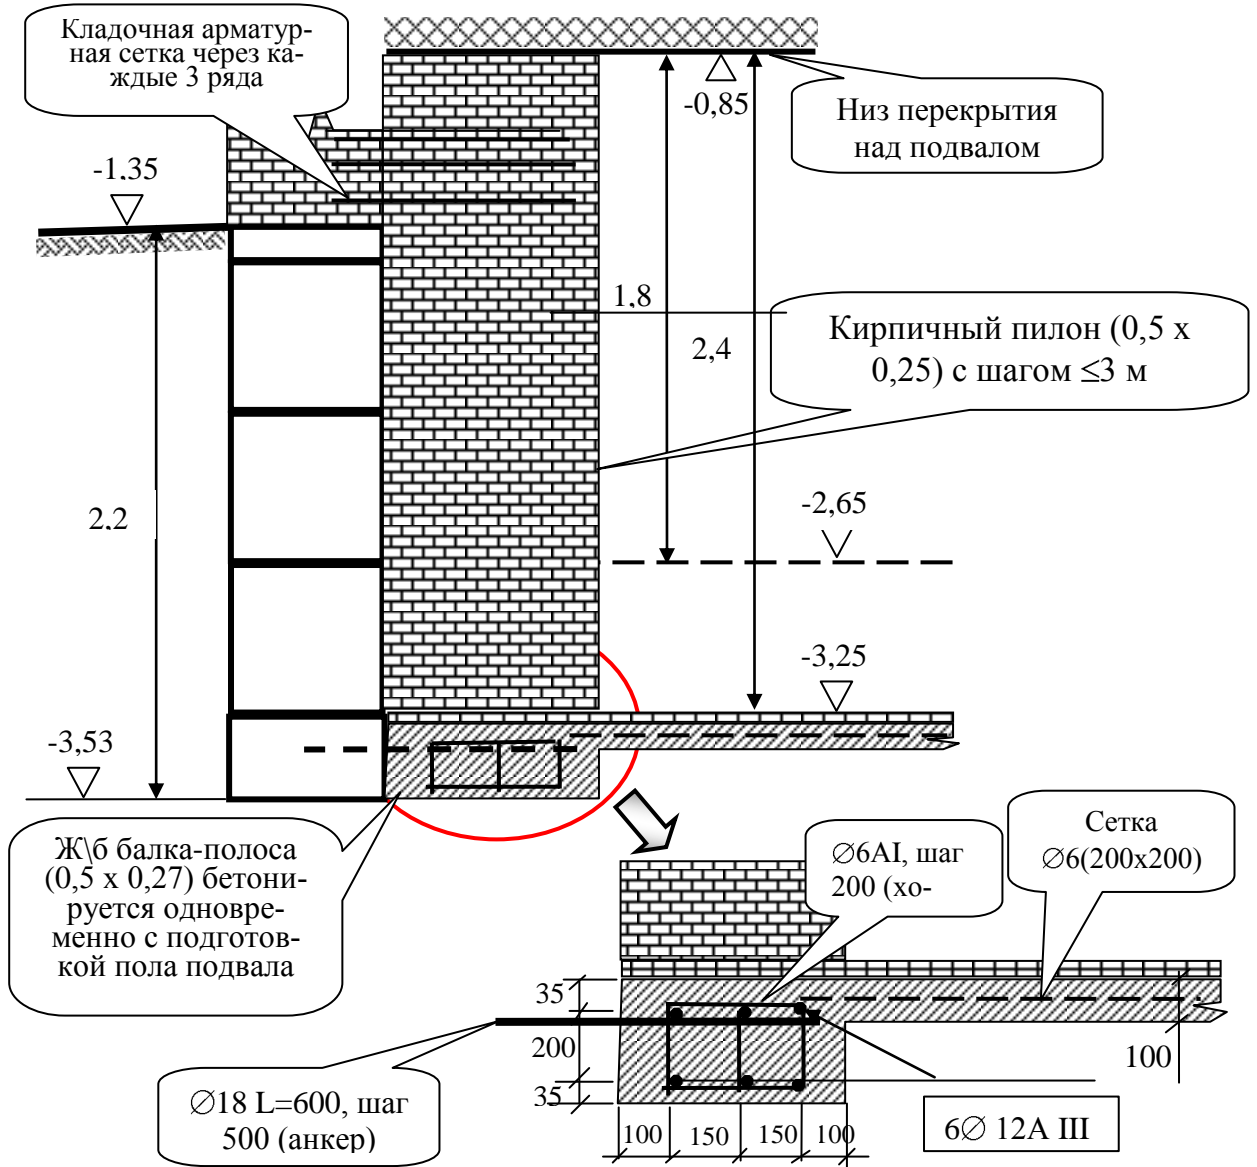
Схема варианта конструктивного усиления основания с использованием кирпичного пилон по расчетным сечениям фундаментов 3-3, 13-13 и др. (бетон ж/б балки-полосы В20)
